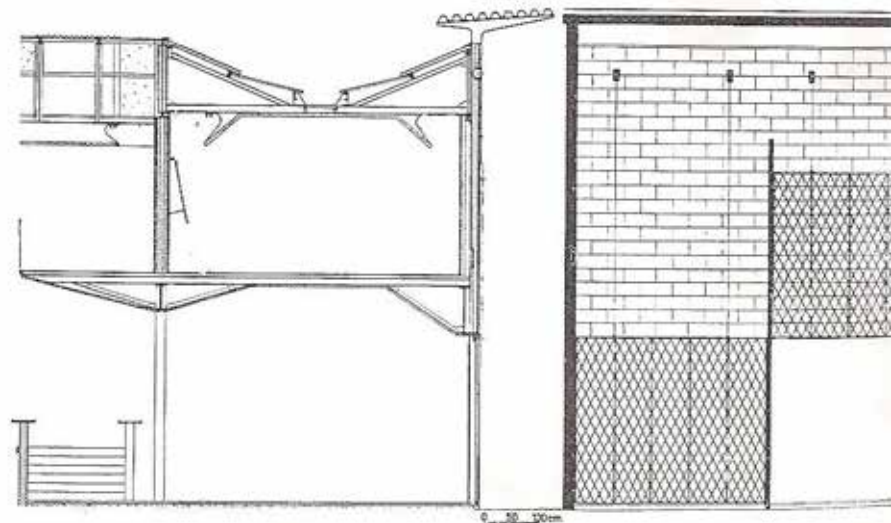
Milano. Galleria d'arte moderna (arch. Ignazio Gardella). Particolare d'una sezione trasversale.
